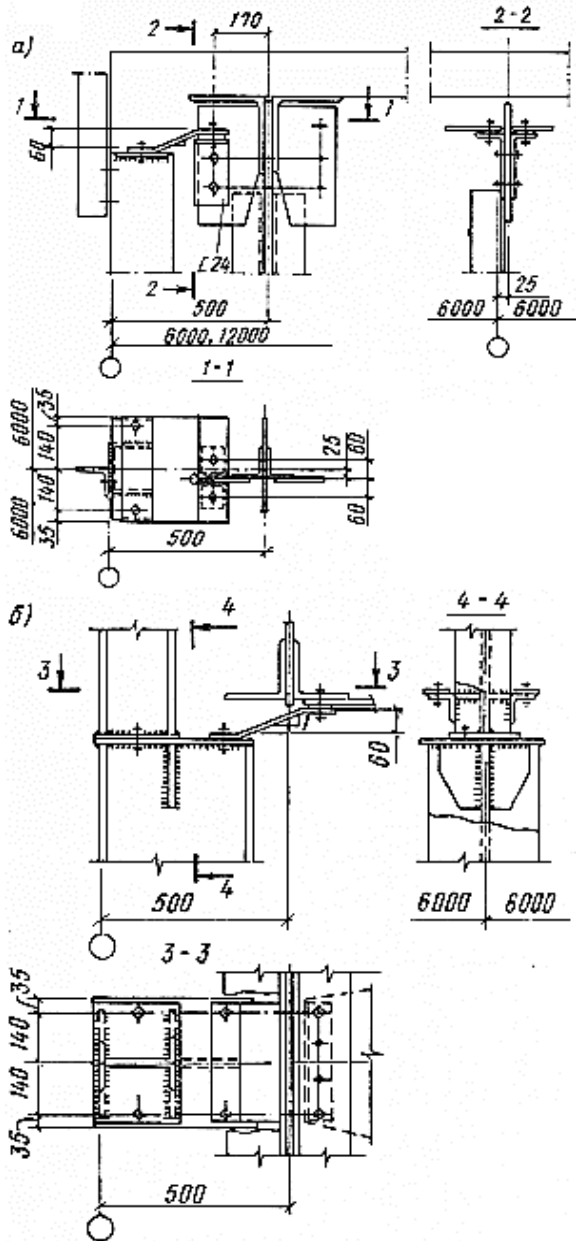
Узлы кріплення стійок фахверка до покриття: а – до верхнього поясу ферми; б – до нижнього поясу ферми
